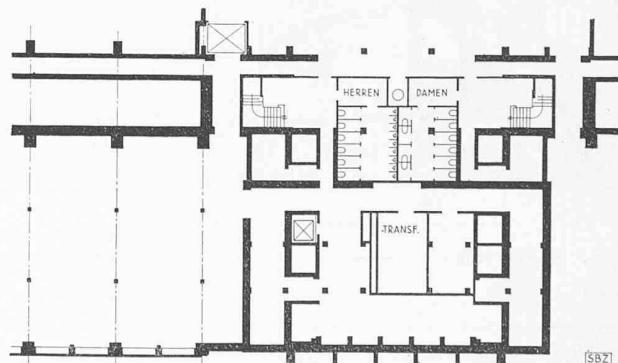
Erdgeschoss 1:600 Bild 17 (rechts). Untergeschosse
